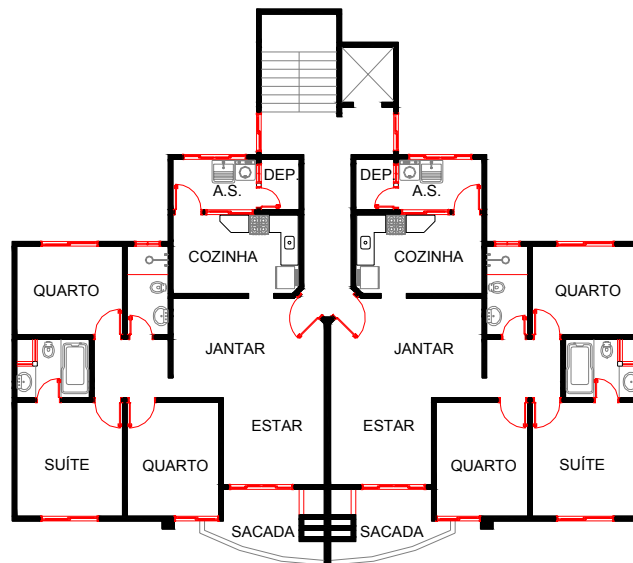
Planta Baixa do pavimento tipo do Estudo de caso D.
